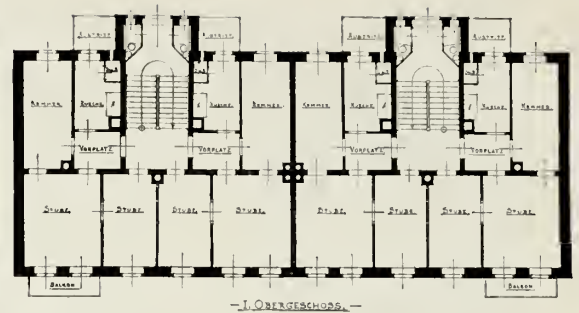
u. 88. Grundrisse des Hauses für Volkswohl.
